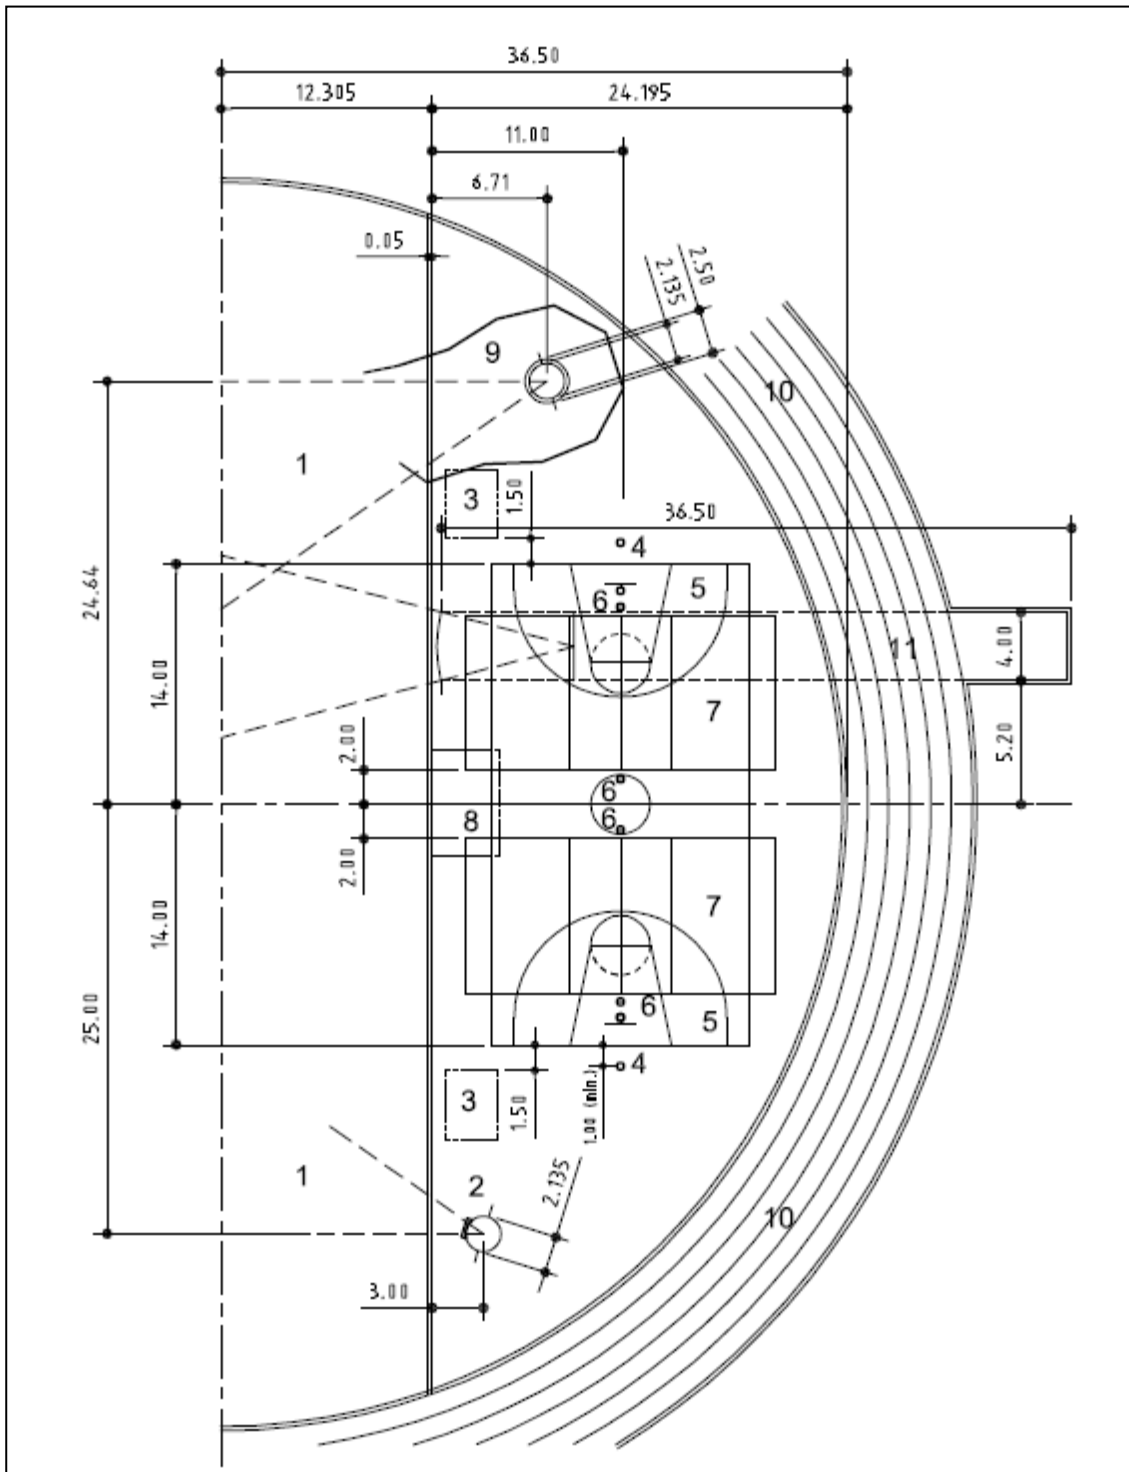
détail du segment sud (1^{er} virage) du plan présenté à la figure 2.6.2b (dimensions en m)
